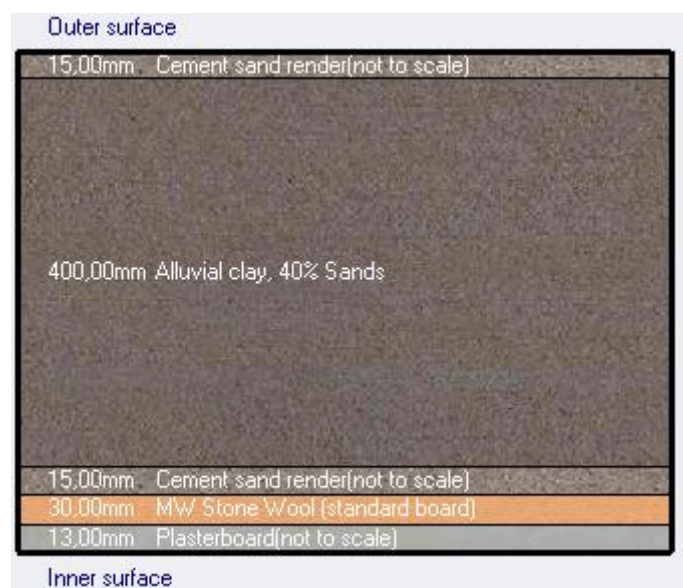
Corte da parede exterior após reabilitação térmica
